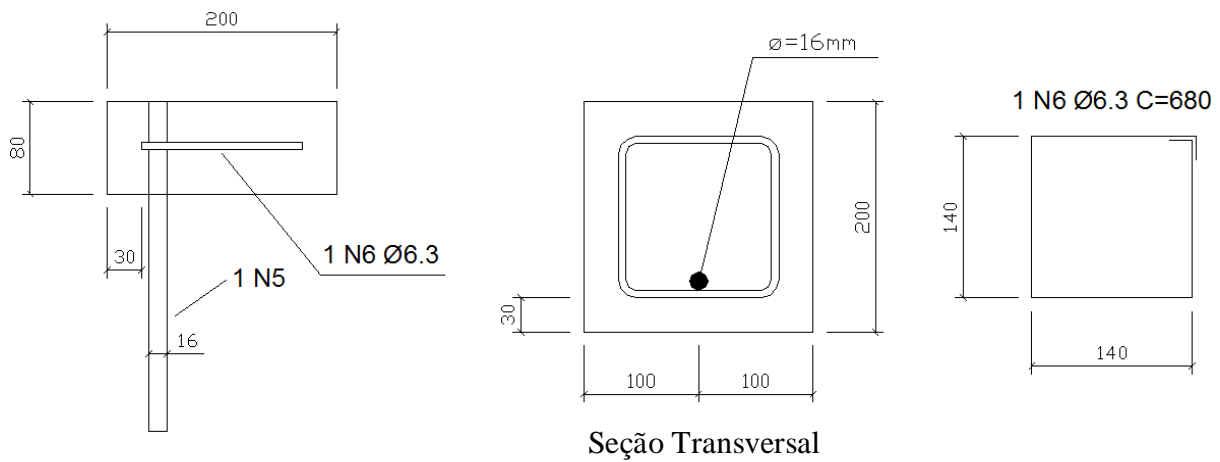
Detalhe do modelo de arrancamento com barras retas de 16 mm com estribos (dimensões em mm)
